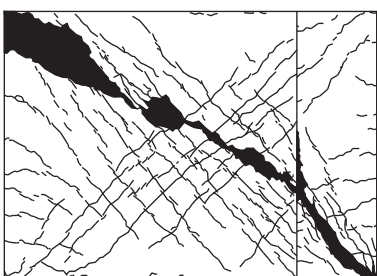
最終ひび割れ状況－A'' タイプ
